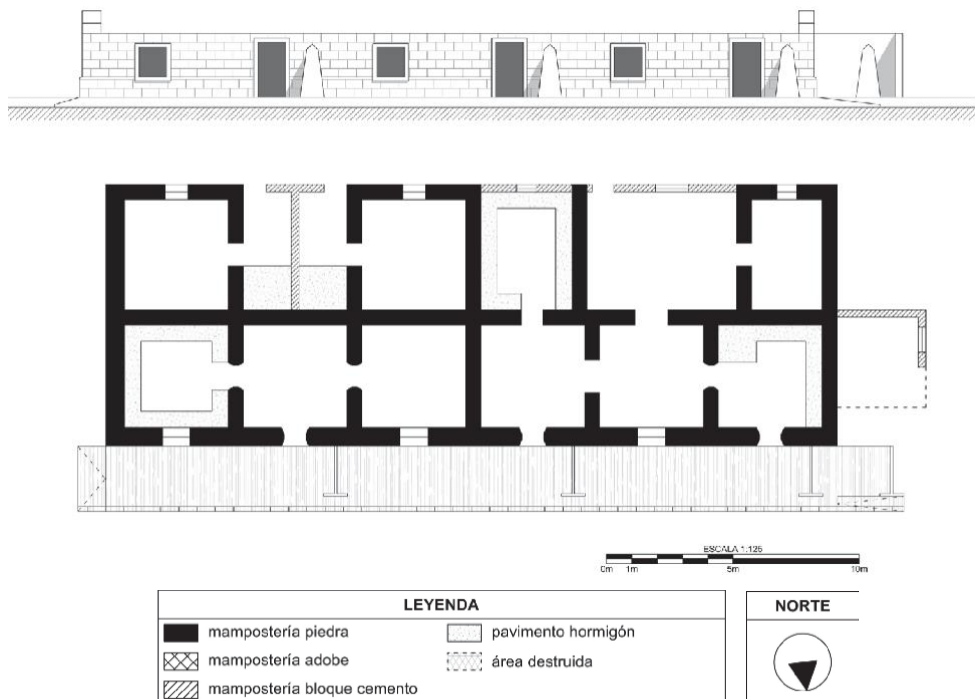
Plano de la estación ferroviaria de Puquios. Fuente: Felipe Rovano 2017.
